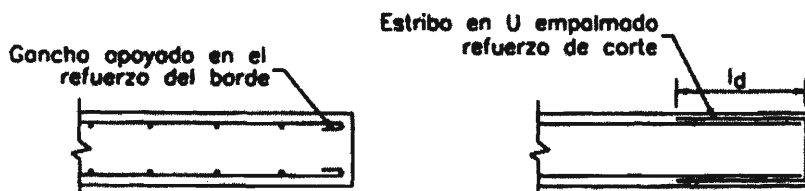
Anclaje del refuerzo horizontal de muros si no existe elemento de confinamiento
